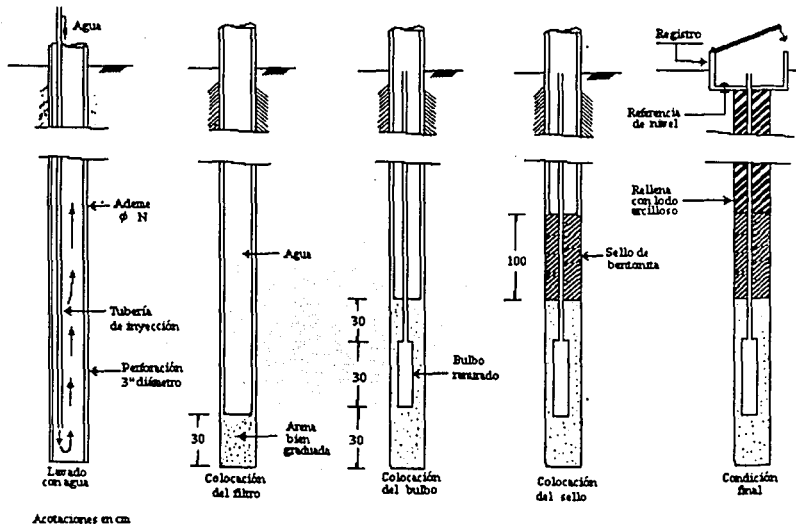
Secuencia de Instalación de un piezómetro.
